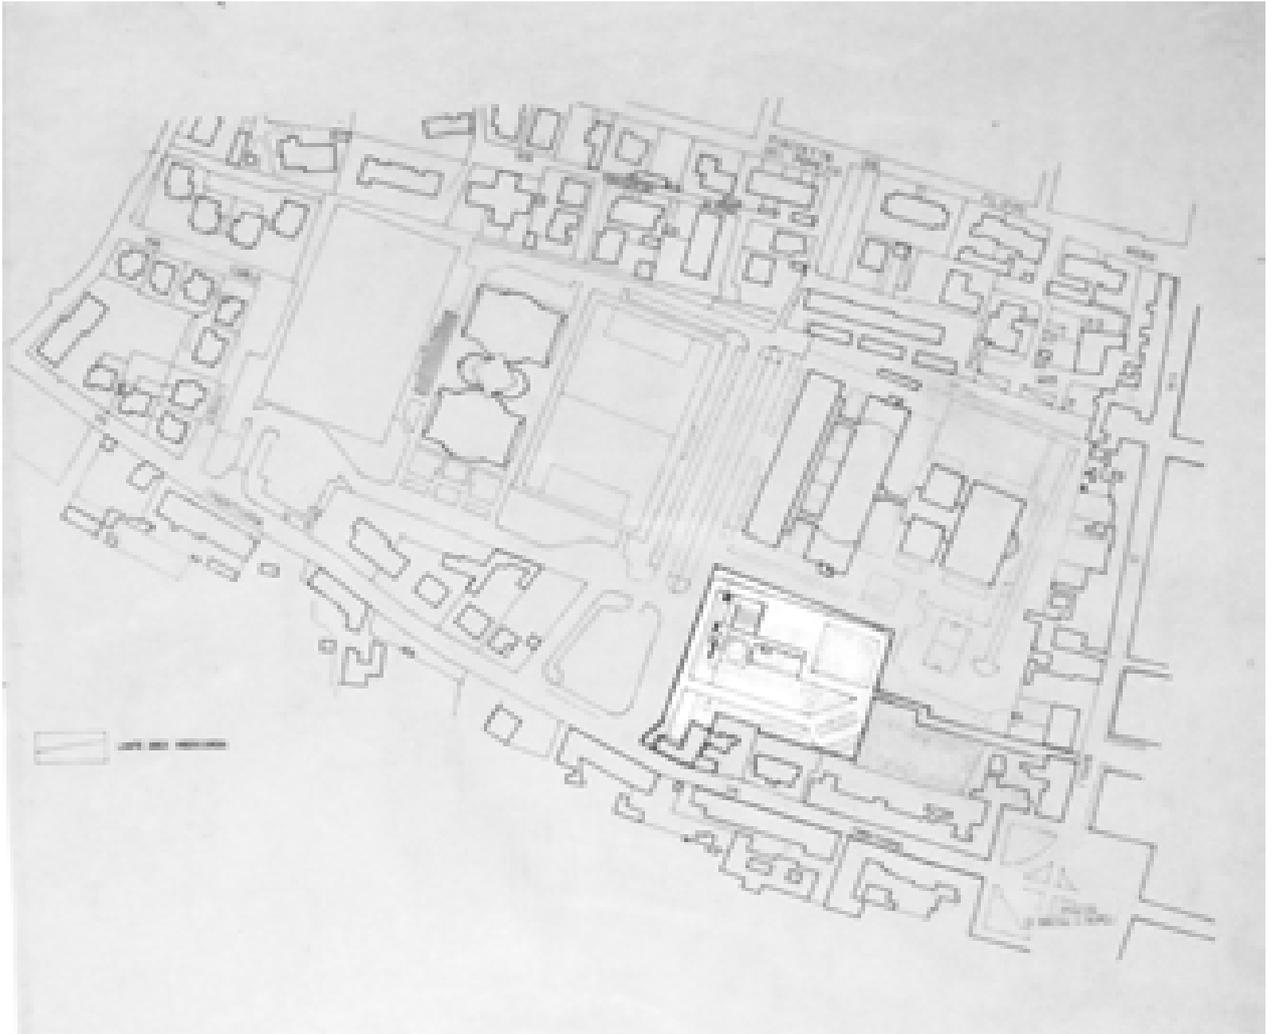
Planimetria, stato futuro – 23/10/1996 (AABS-64_47)
